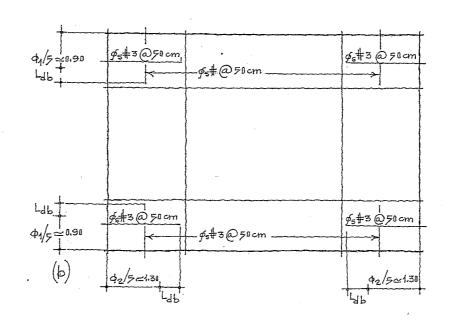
Planta de la losa mostrando los armados en ambos sentidos, (4).
